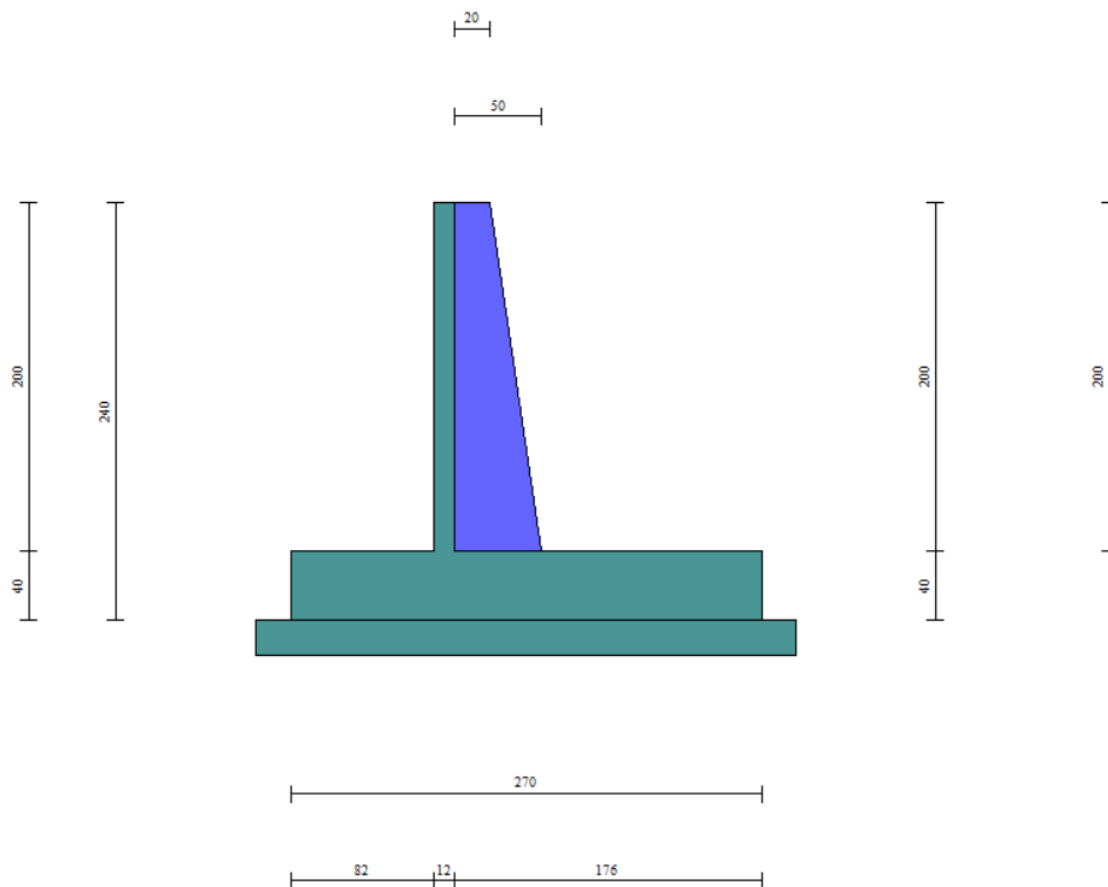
Geometria dei MURI DI SOTTOSCARPA - FONDAZIONE DIRETTA - TIPO 4
